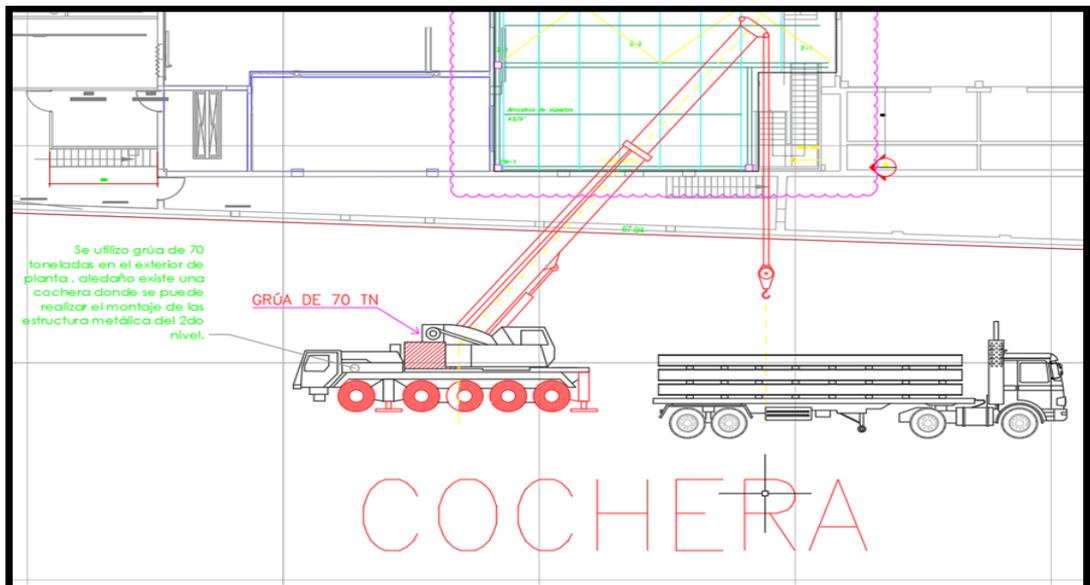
Corte 2 de Layout de Montaje de Estructura Metálica 1er nivel
